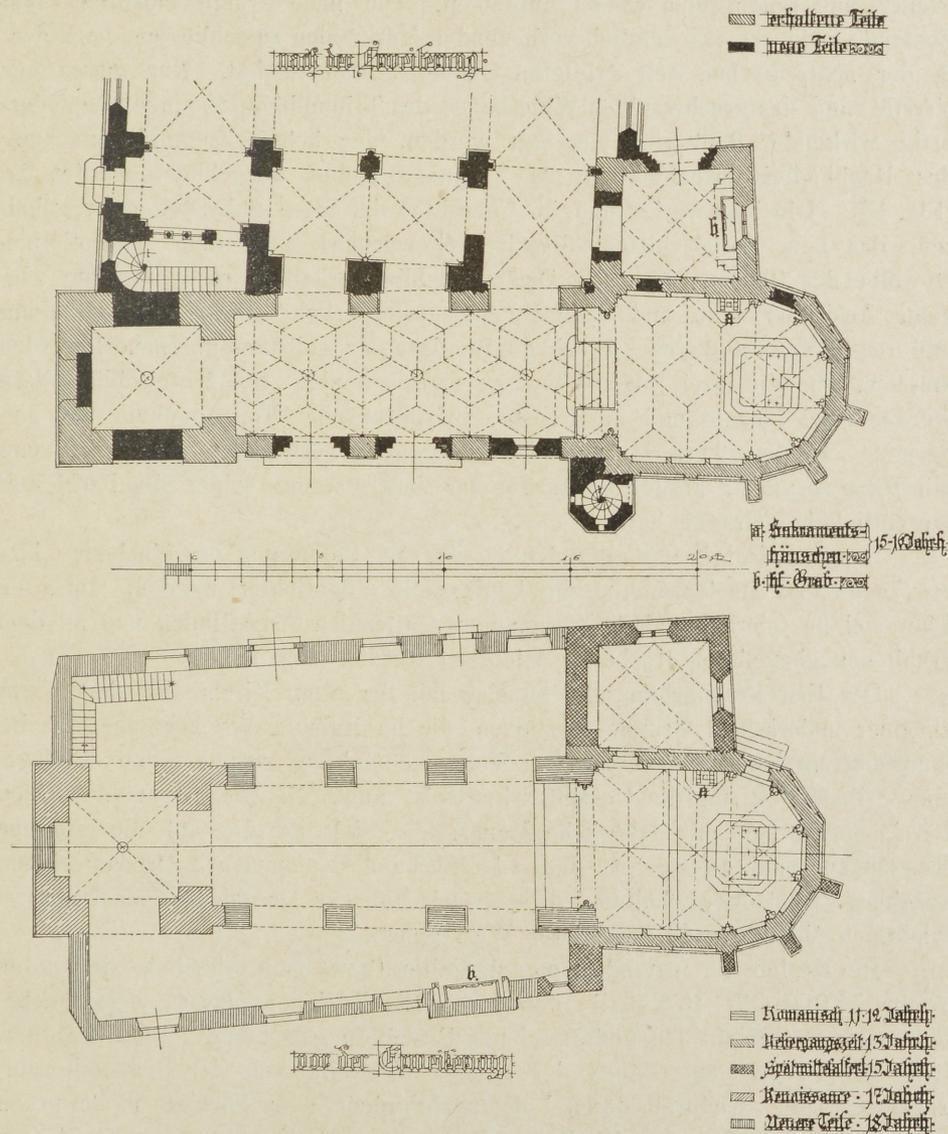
Remagen. Grundrisse der alten kath. Pfarrkirche vor und nach der Erweiterung.
